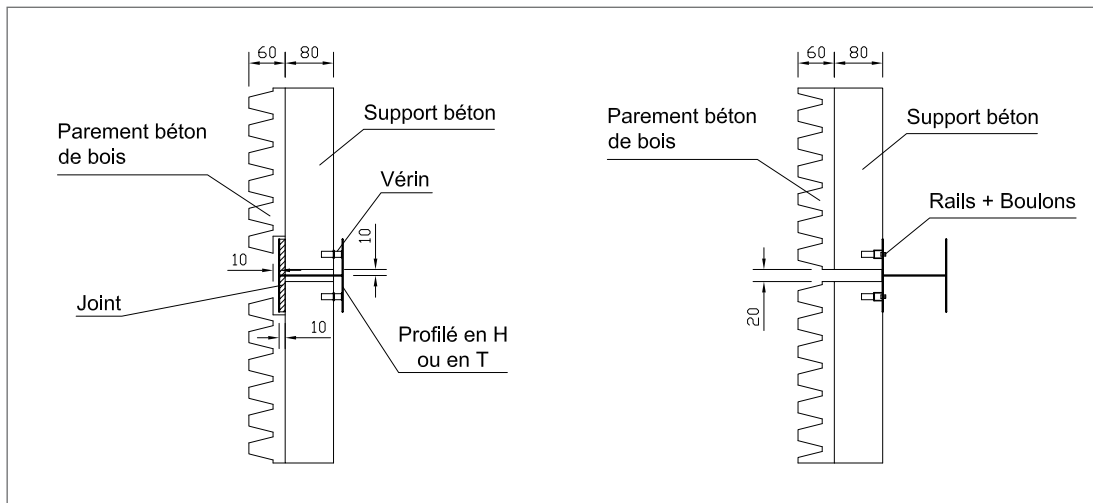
Schéma de principe des fixations des panneaux béton, à gauche par l'arrière, à droite par l'avant
